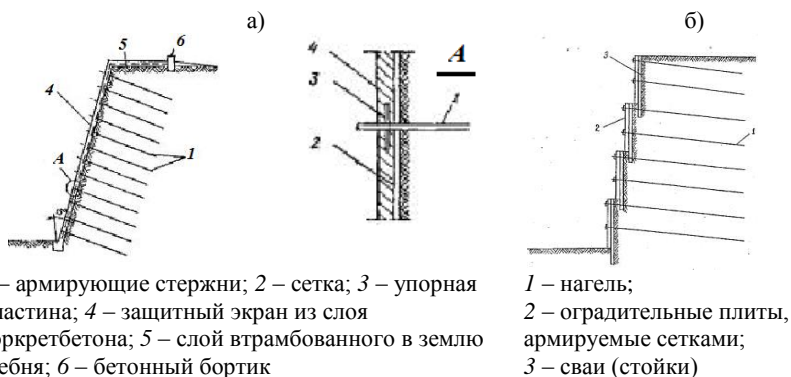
Схема нагельного крепления с защитной поверхностью откоса котлована торкретбетоном (а); со сборной защитной стенкой (б)
